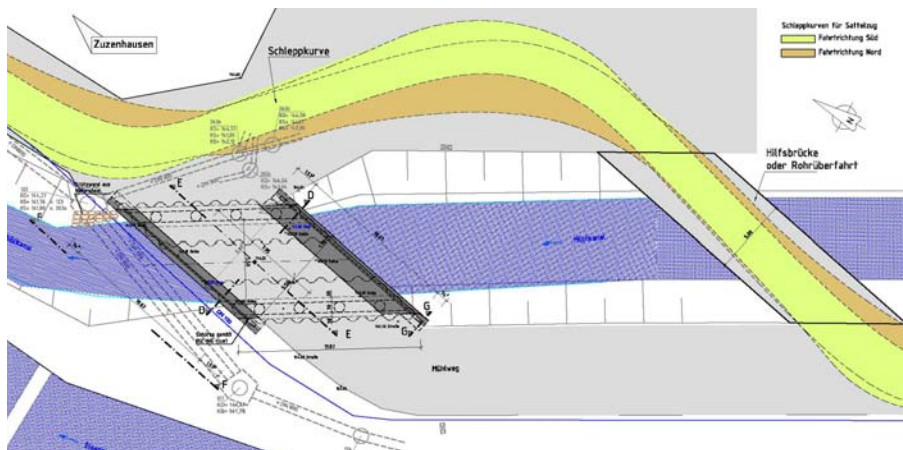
Planung der neuen Brücke mit Spundwandverbau und Hilfsbrücke
